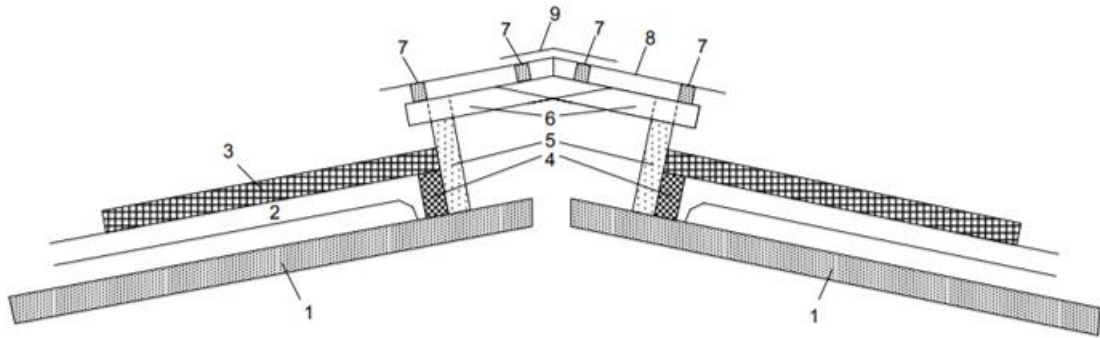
Конструкція з профільного полікарбонату, де: 1) залізобетонні балки перекриття; 2) поздовжній брус; 3) профнастил; 4) опорна планка; 5) несуча конструкція (поперекова планка); 6) каркасні планки; 7) поздовжня планка; 8) прозорий шифер; 9) смужка з оцинкованого металу.
